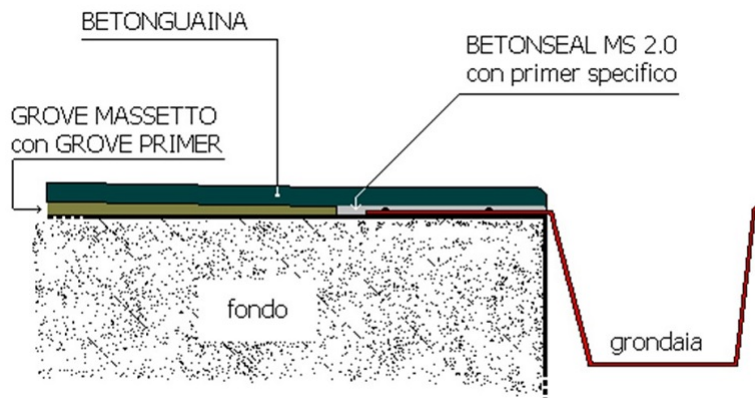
Preparazione del sottofondo con grondaie e scossaline già precedentemente posate: sigillatura e posa di BETONGUAINA.
